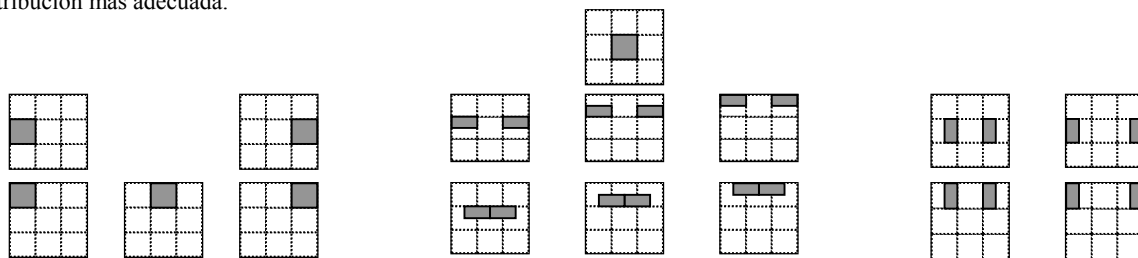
Alternativas de ubicación de aberturas en muro Norte
